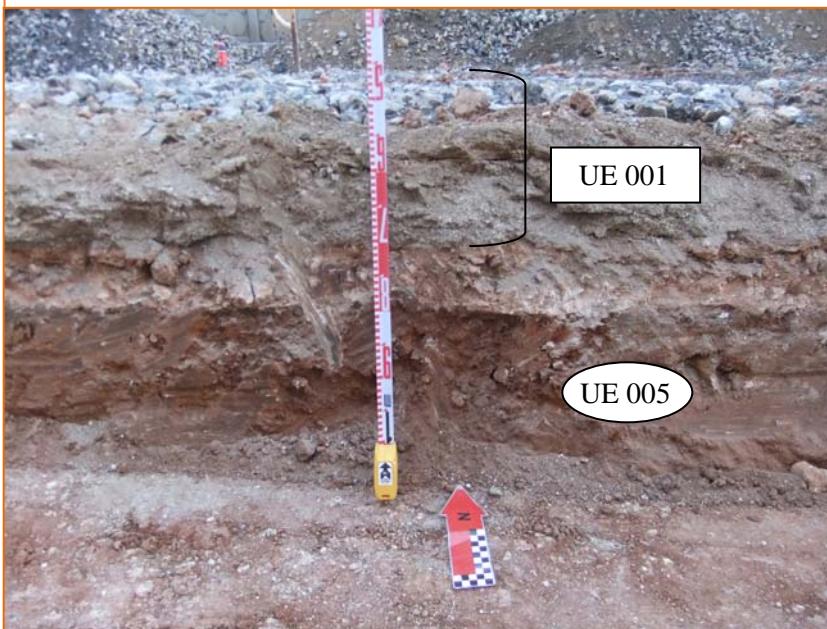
Caixó de la carretera. Vista de la secció estratigràfica.
